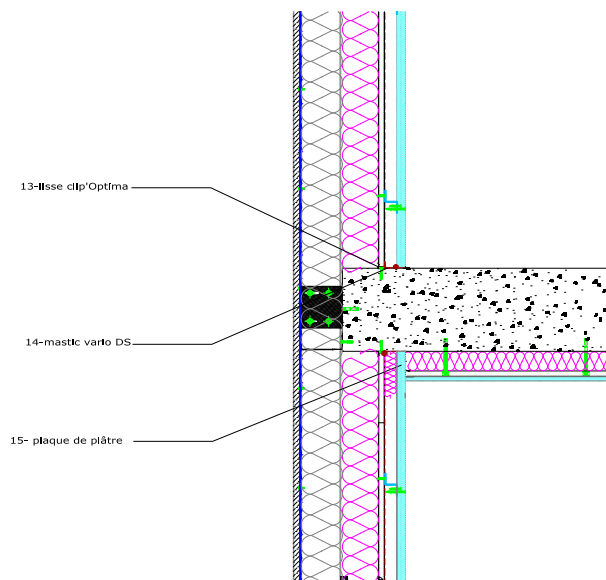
Liaison Façade F4 / Plancher intermédiaire avec faux-plafond isolé
